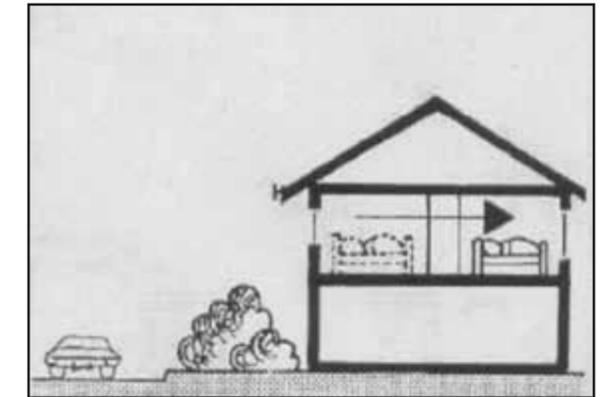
Lärmabgewandter Wohnungsgrundriss
